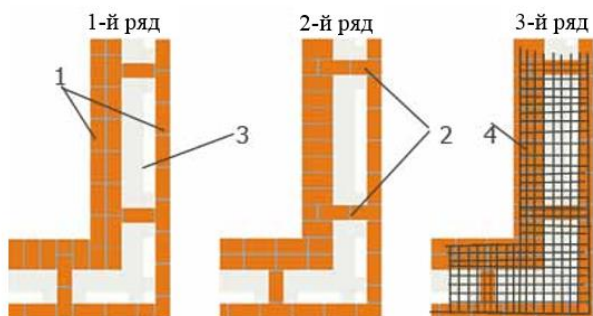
Пример фрагмента кирпичной колодцевой кладки: 1 – наружные стенки колодцев; 2 – вертикальные диафрагмы; 3 – колодец с утеплителем; 4 – армирующая сетка (горизонтальная диафрагма)
